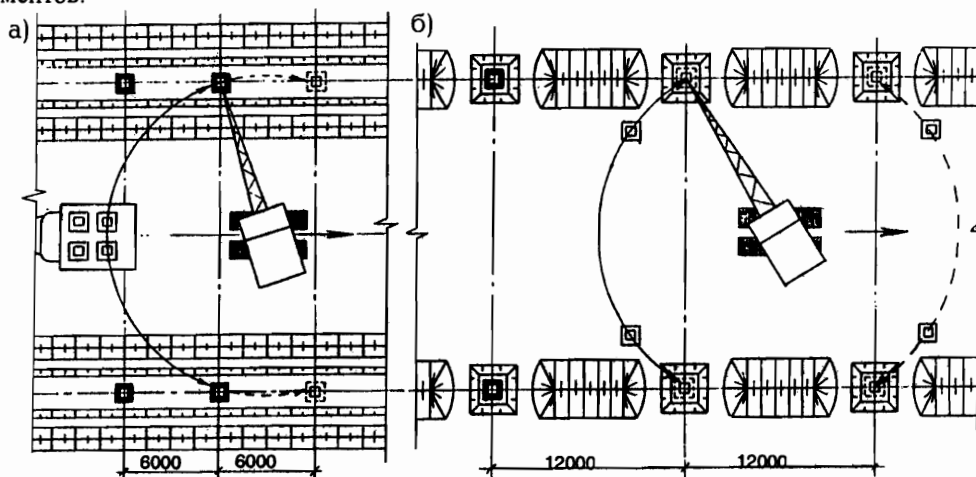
Монтаж фундаментов: а – с транспортных средств; б – с предварительной раскладкой элементов
